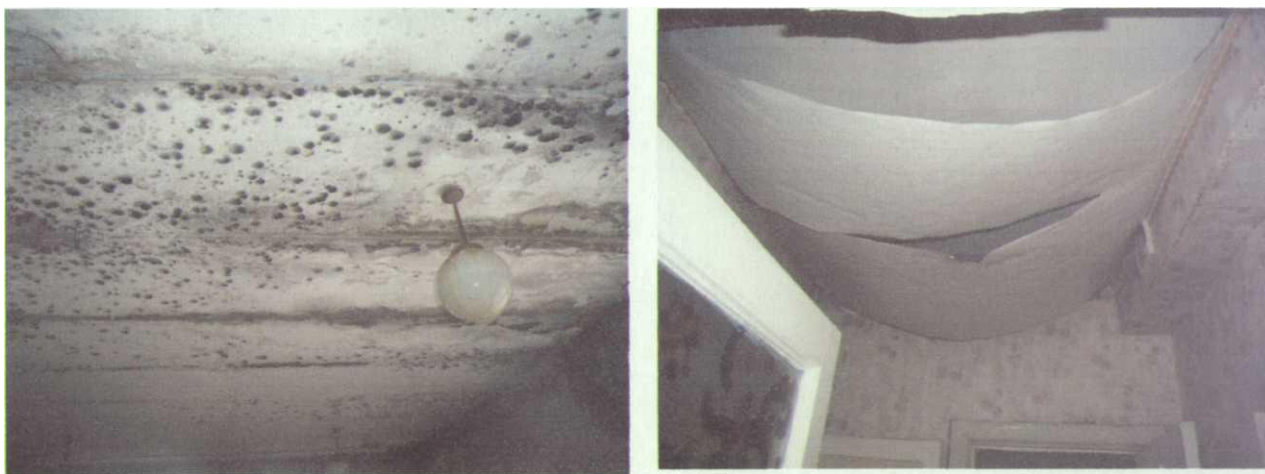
Дефекты плит перекрытия второго этажа, поражение грибком поверхности плит.
